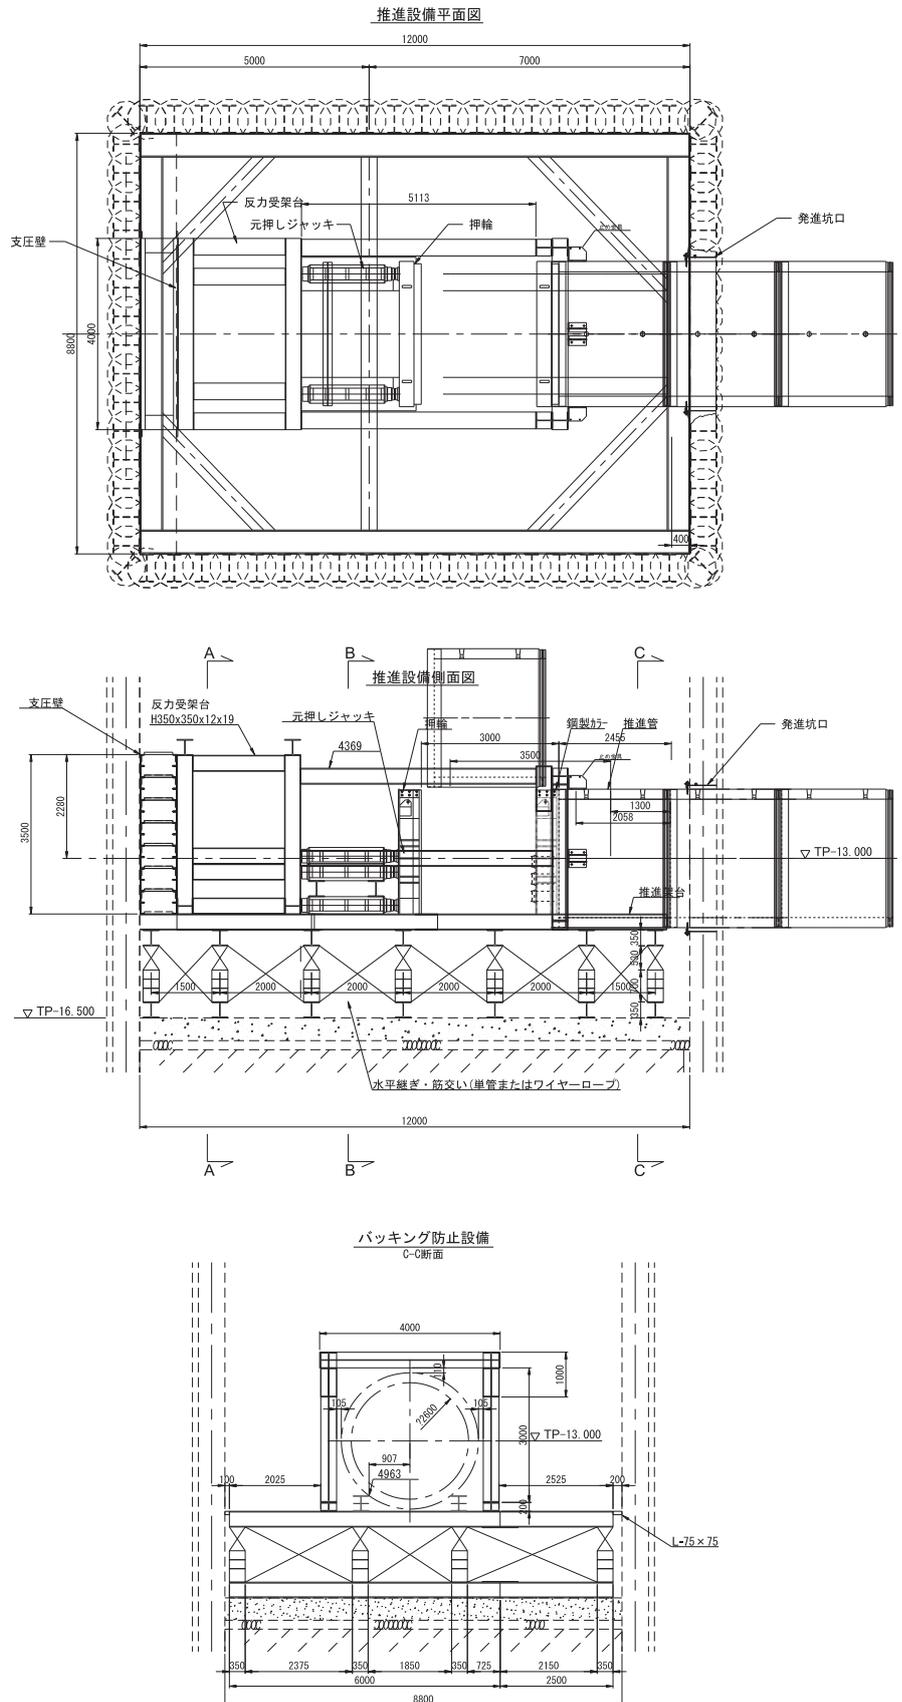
Backingアンカ方式 (平面・側面・断面図) 参考
